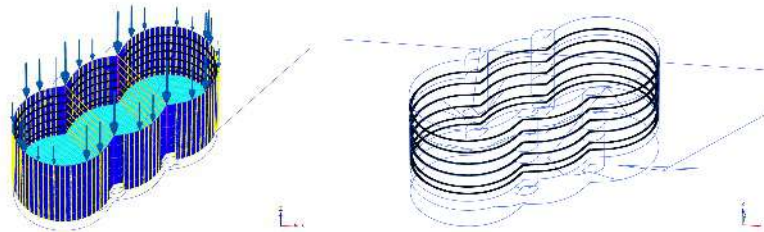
Geometria do modelo tridimensional de cálculo (PLAXIS 3D) – Elementos estruturais: parede de contenção, anéis, pórticos e laje de fundo
